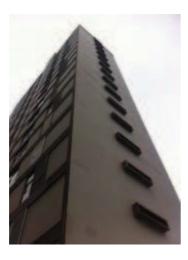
Fachada do Condomínio Edifício Cabo Verde.
